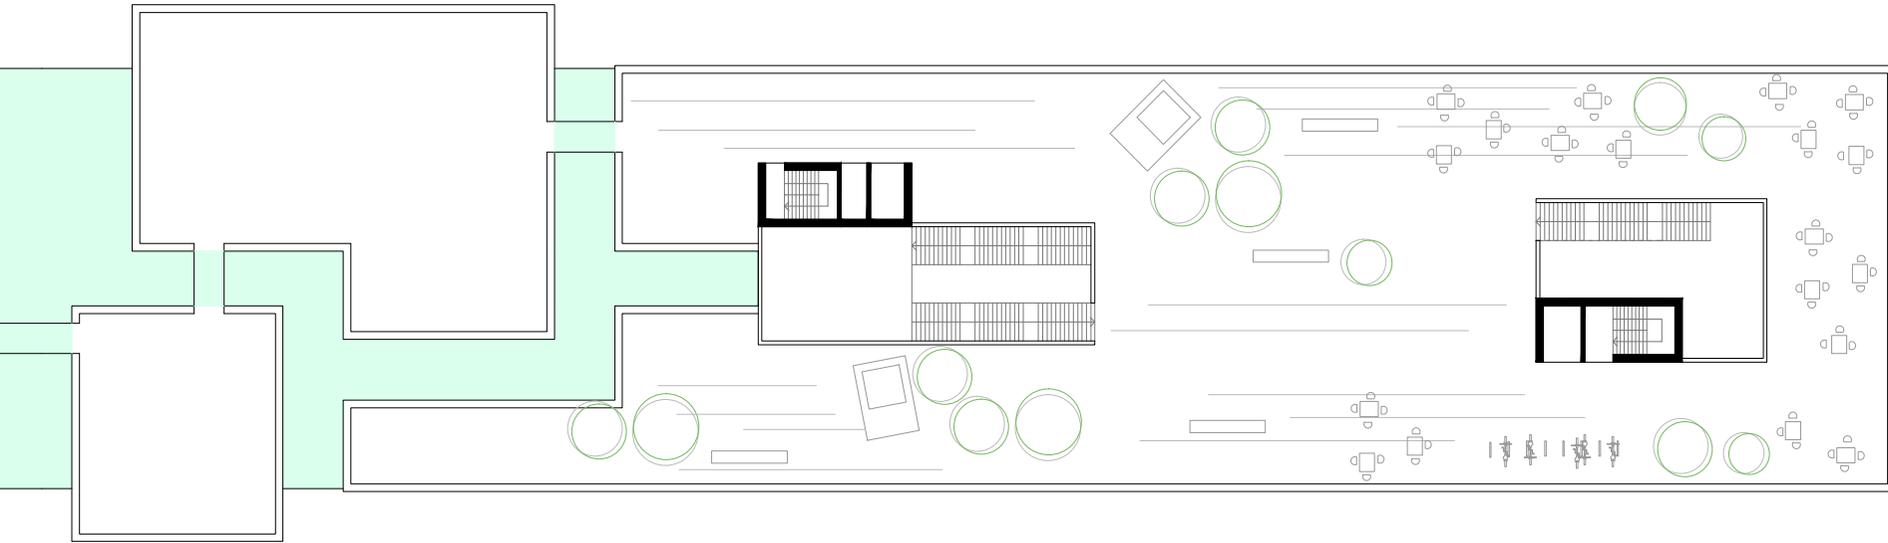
GRUNDRISS DACHEBENE I_500
